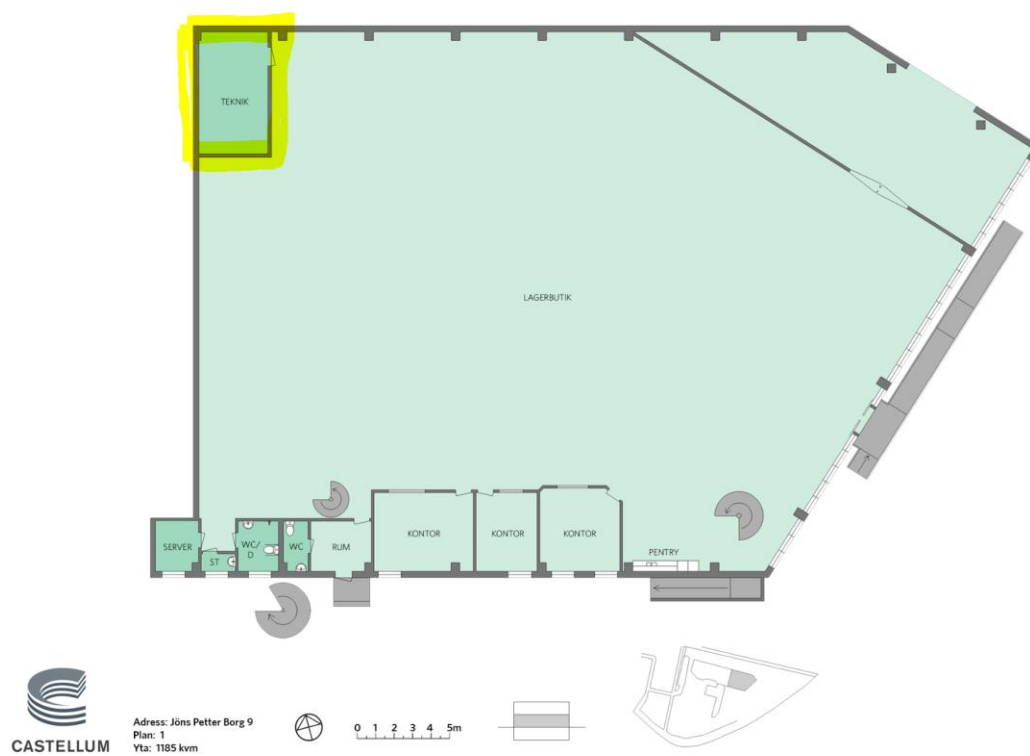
; (Ventilationsrum- ventilationsanläggning efter anpassning till padelverksamhet = samma som innan, se bild 2)
